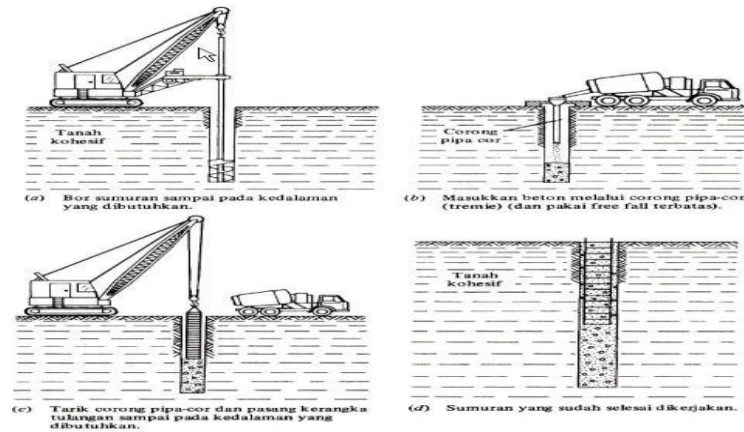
Jenis-Jenis Pondasi Bored Pile
